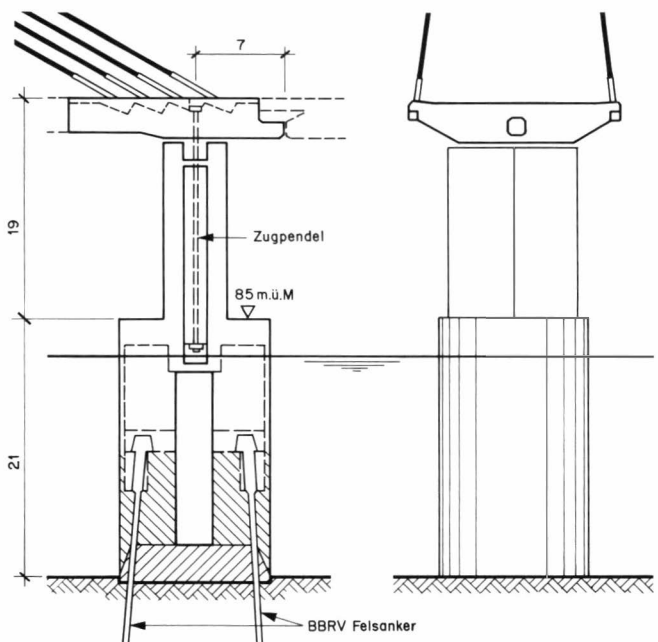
Seitenpfeiler, Längsschnitt (links) und Querschnitt (rechts), Masse in m – Coupe longitudinale (à gauche) et coupe en travers (à droite) d'une pile latérale (dimensions en m) – Side pier in elevation (left) and section (right), Dimensions in m
